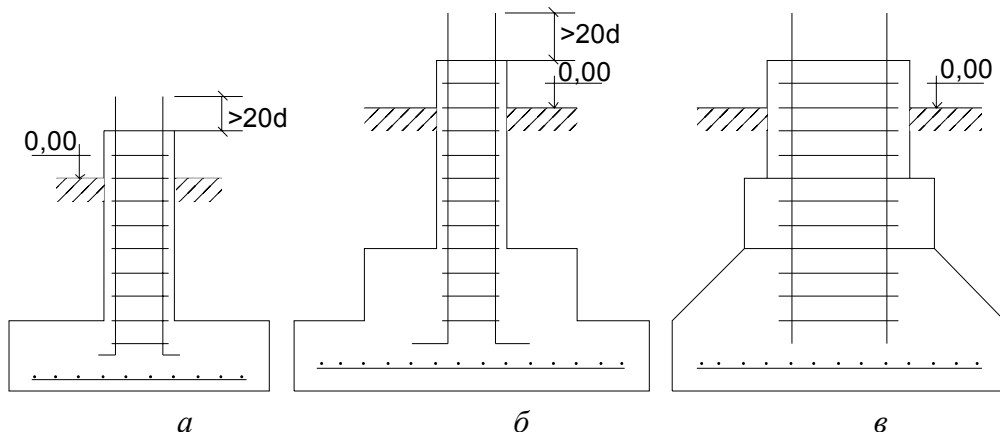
Монолітні стовпчасті фундаменти:
